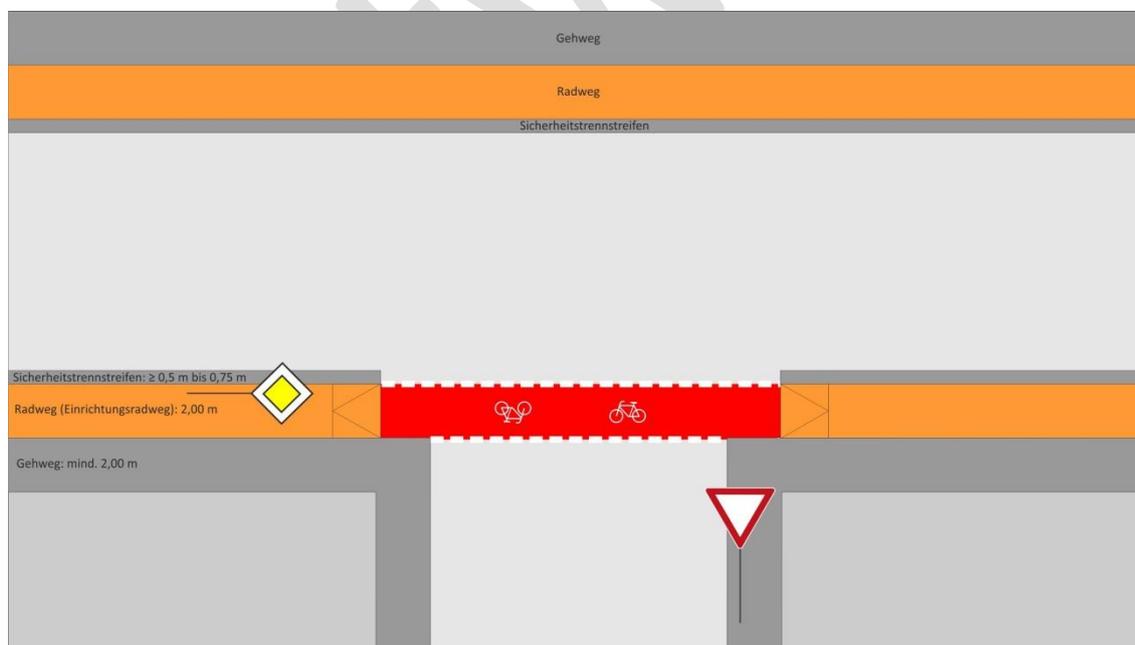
Rote Furtmarkierung an Knotenpunkten (gemäß ERA 2010, Kap. 3.4)
